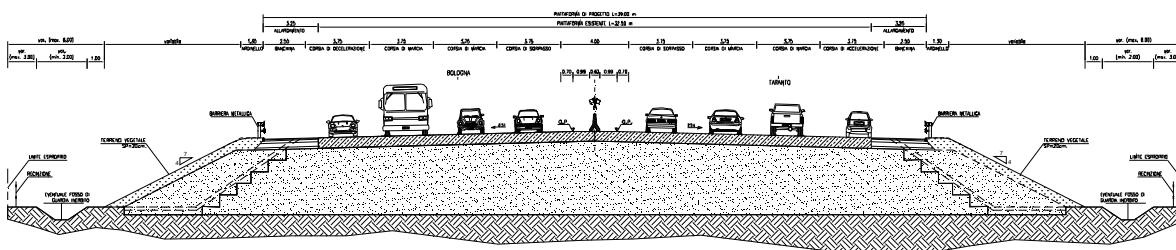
Sezione tipo di progetto in rettilineo con ampliamento simmetrico (rilevato/trincea)
